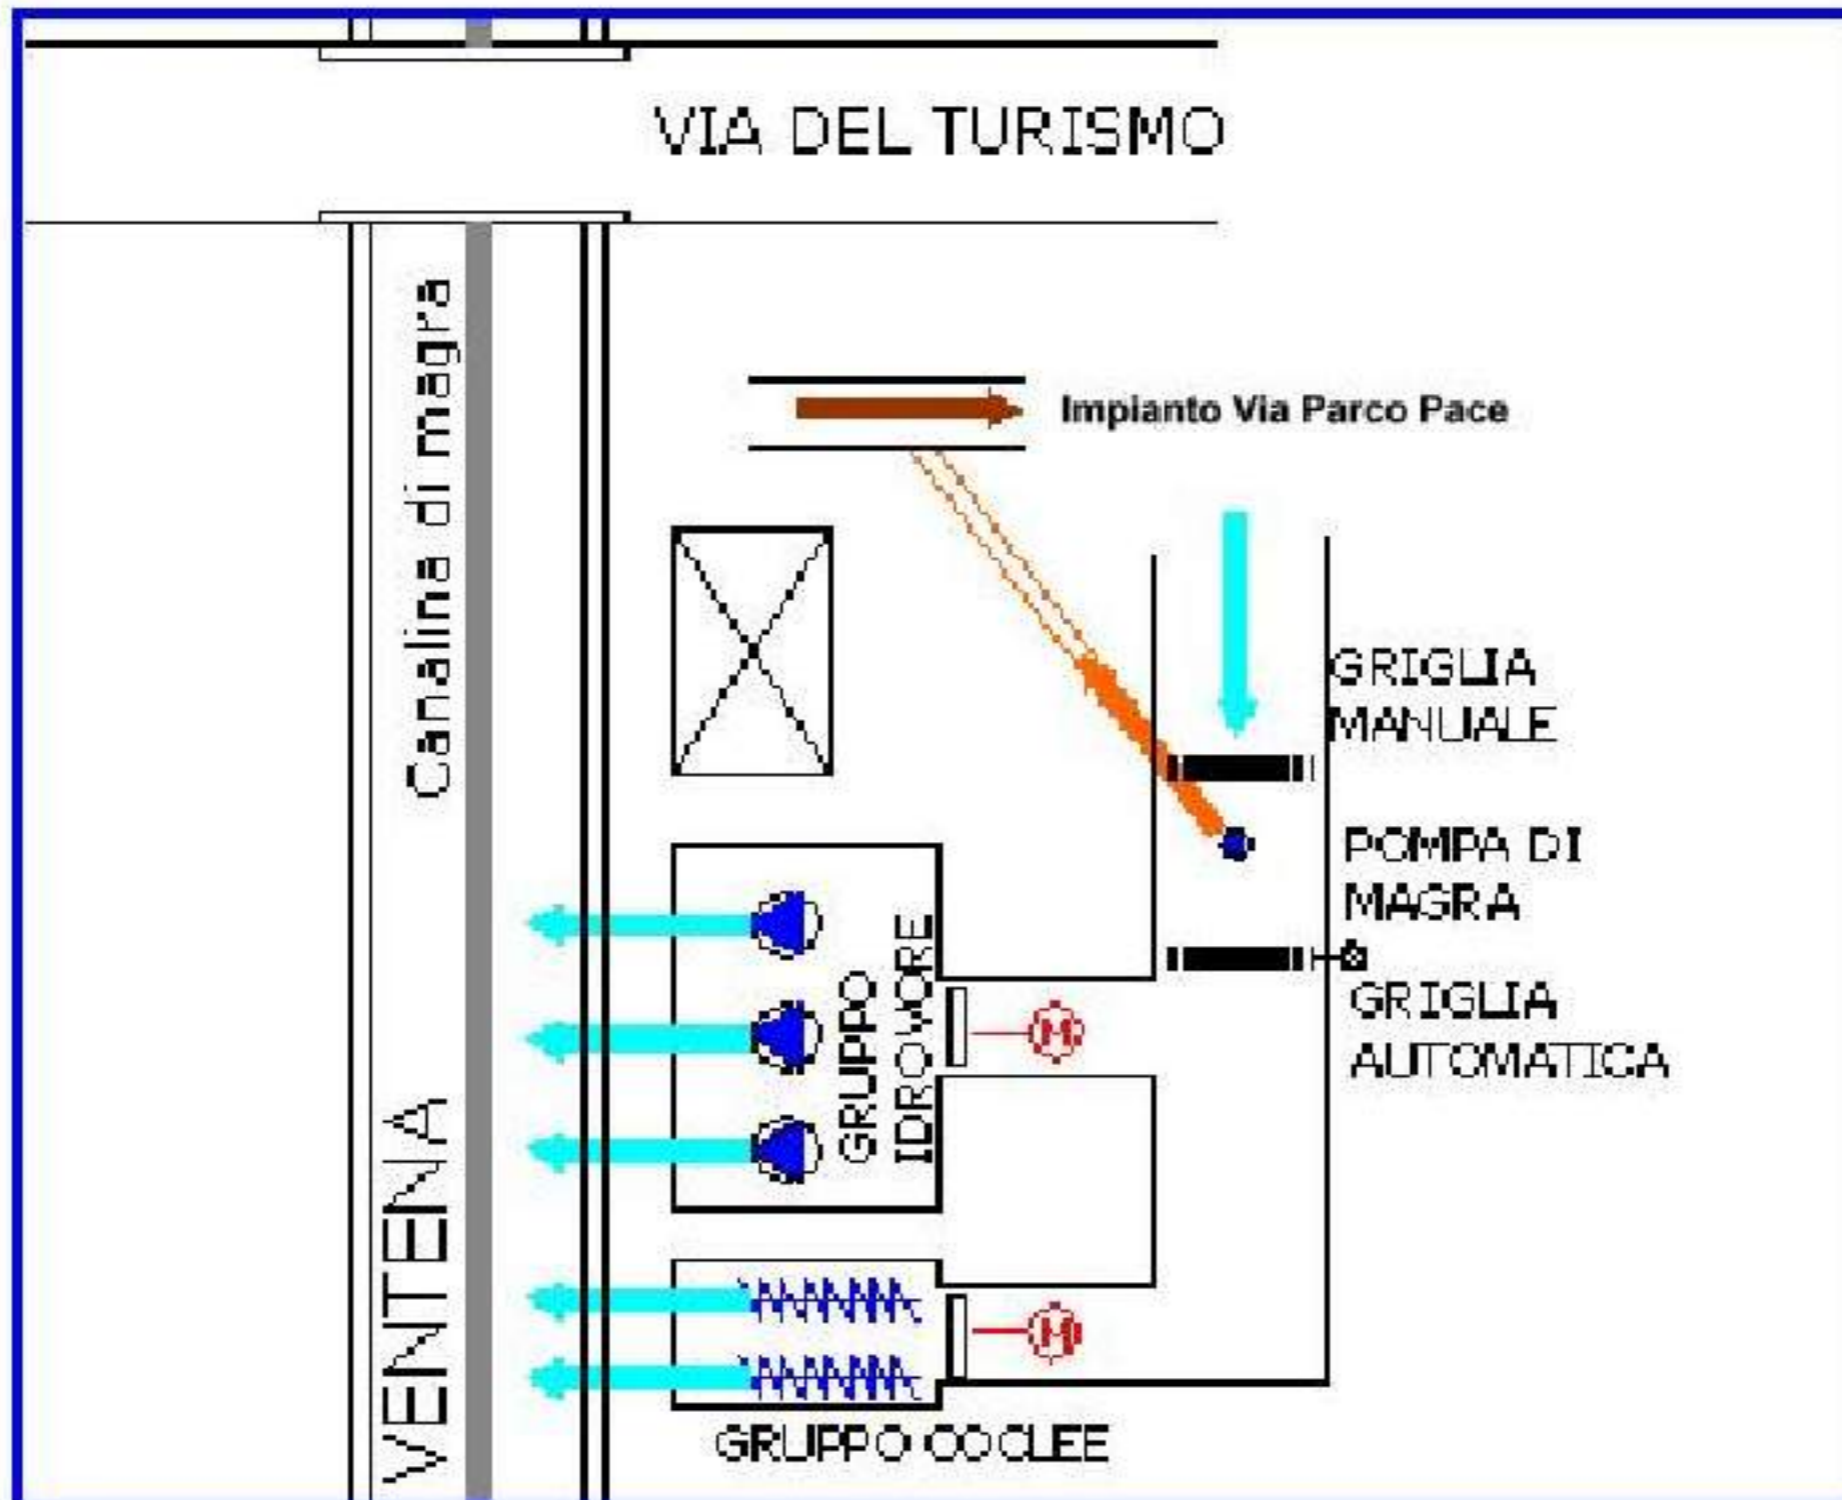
Schema dell'impianto di sollevamento Ventena.
